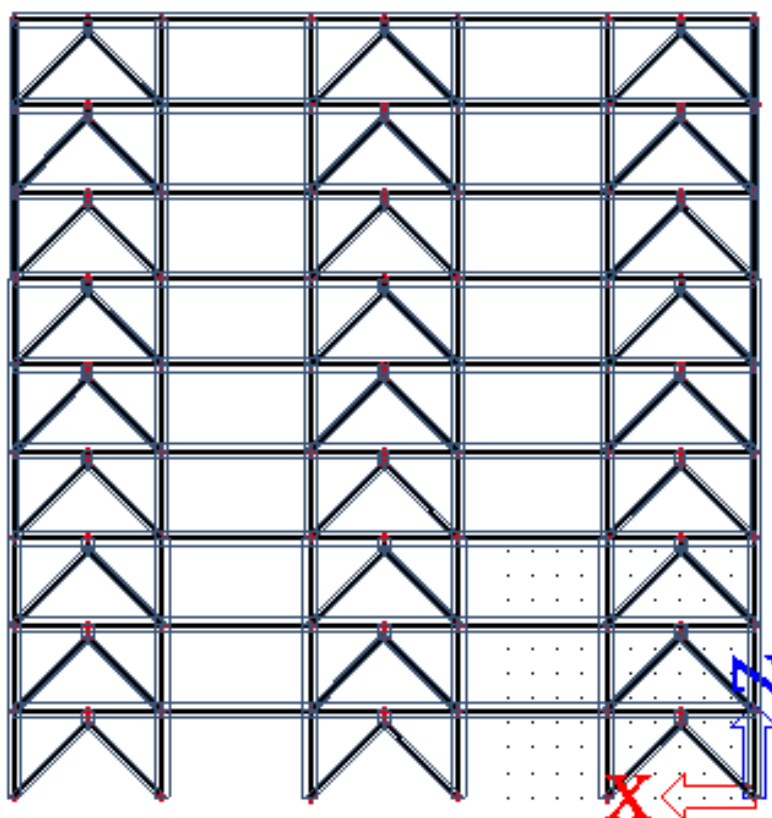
Geometria excentrického stužidla – 9-podlažný rám – varianta 1
